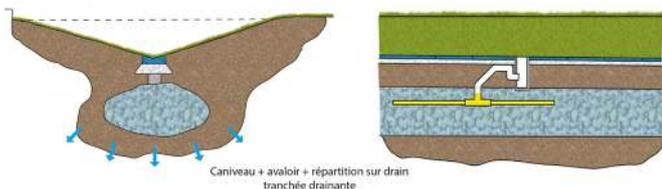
schéma d'une coupe en travers et coupe en long de noue filtrante
